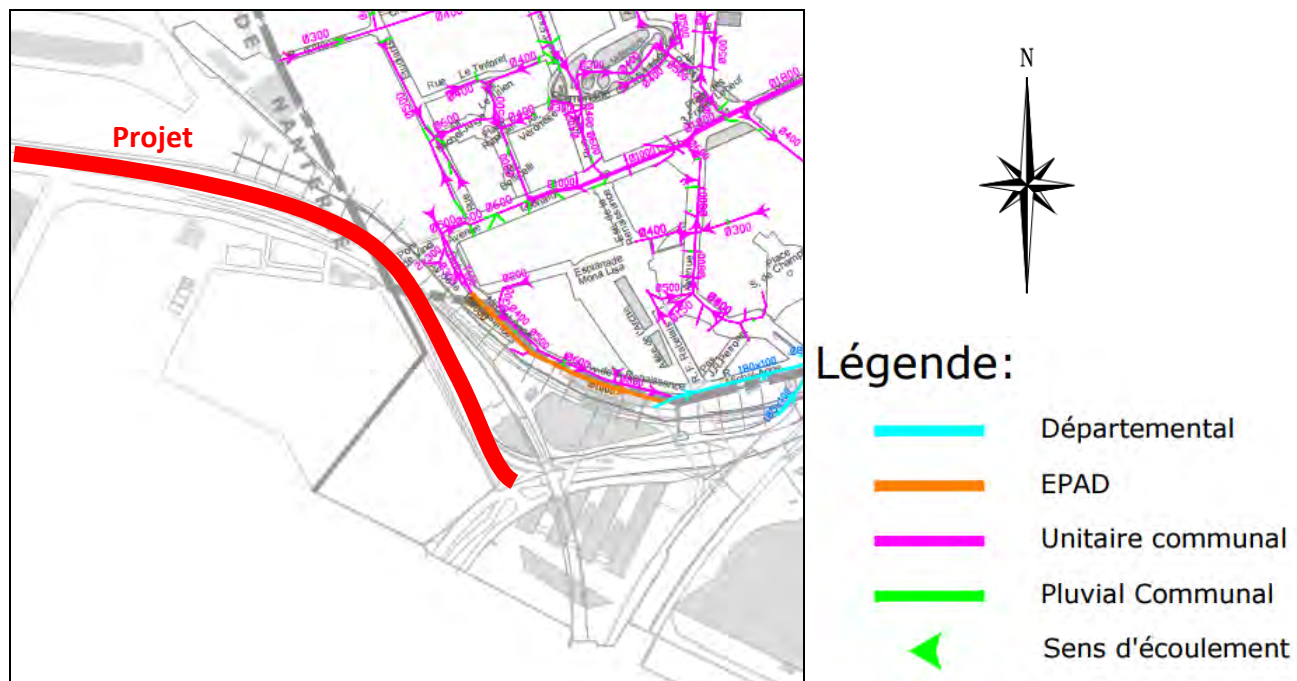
extrait du plan du réseau d'assainissement de Courbevoie
